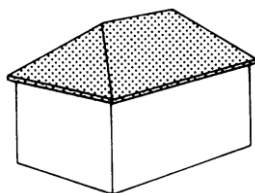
Вальмовая крыша (Stanley Tools)
